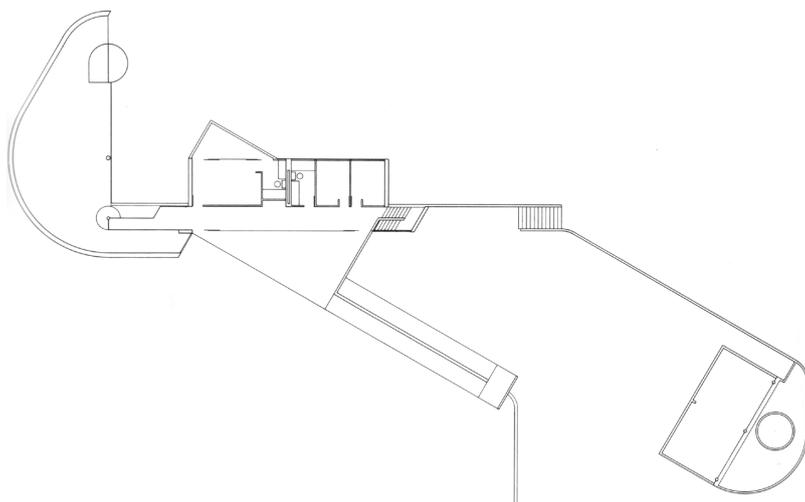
Michael Dolinski, *Gris House* (1967-1968). Planta baixa.
